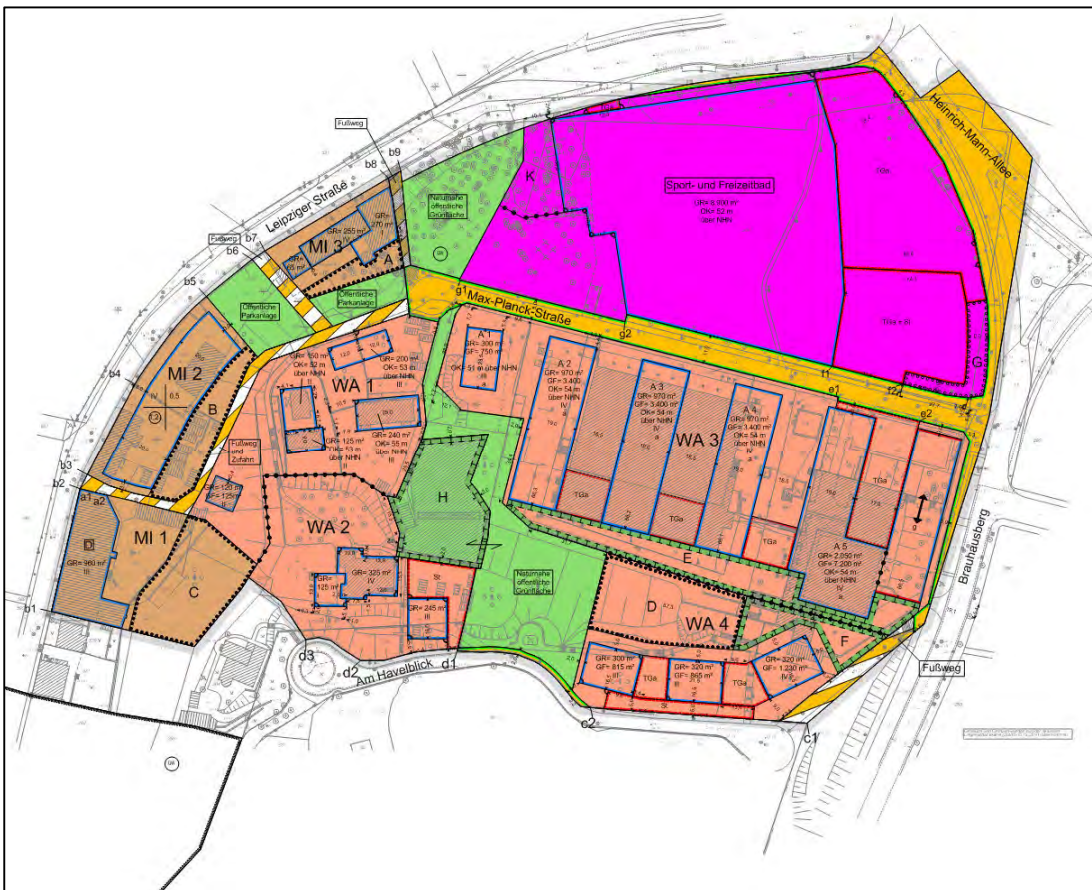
Bebauungsplan Nr. 36-2, „Leipziger Straße / Brauhausberg“ [B-PLAN_36-2, 2014]
